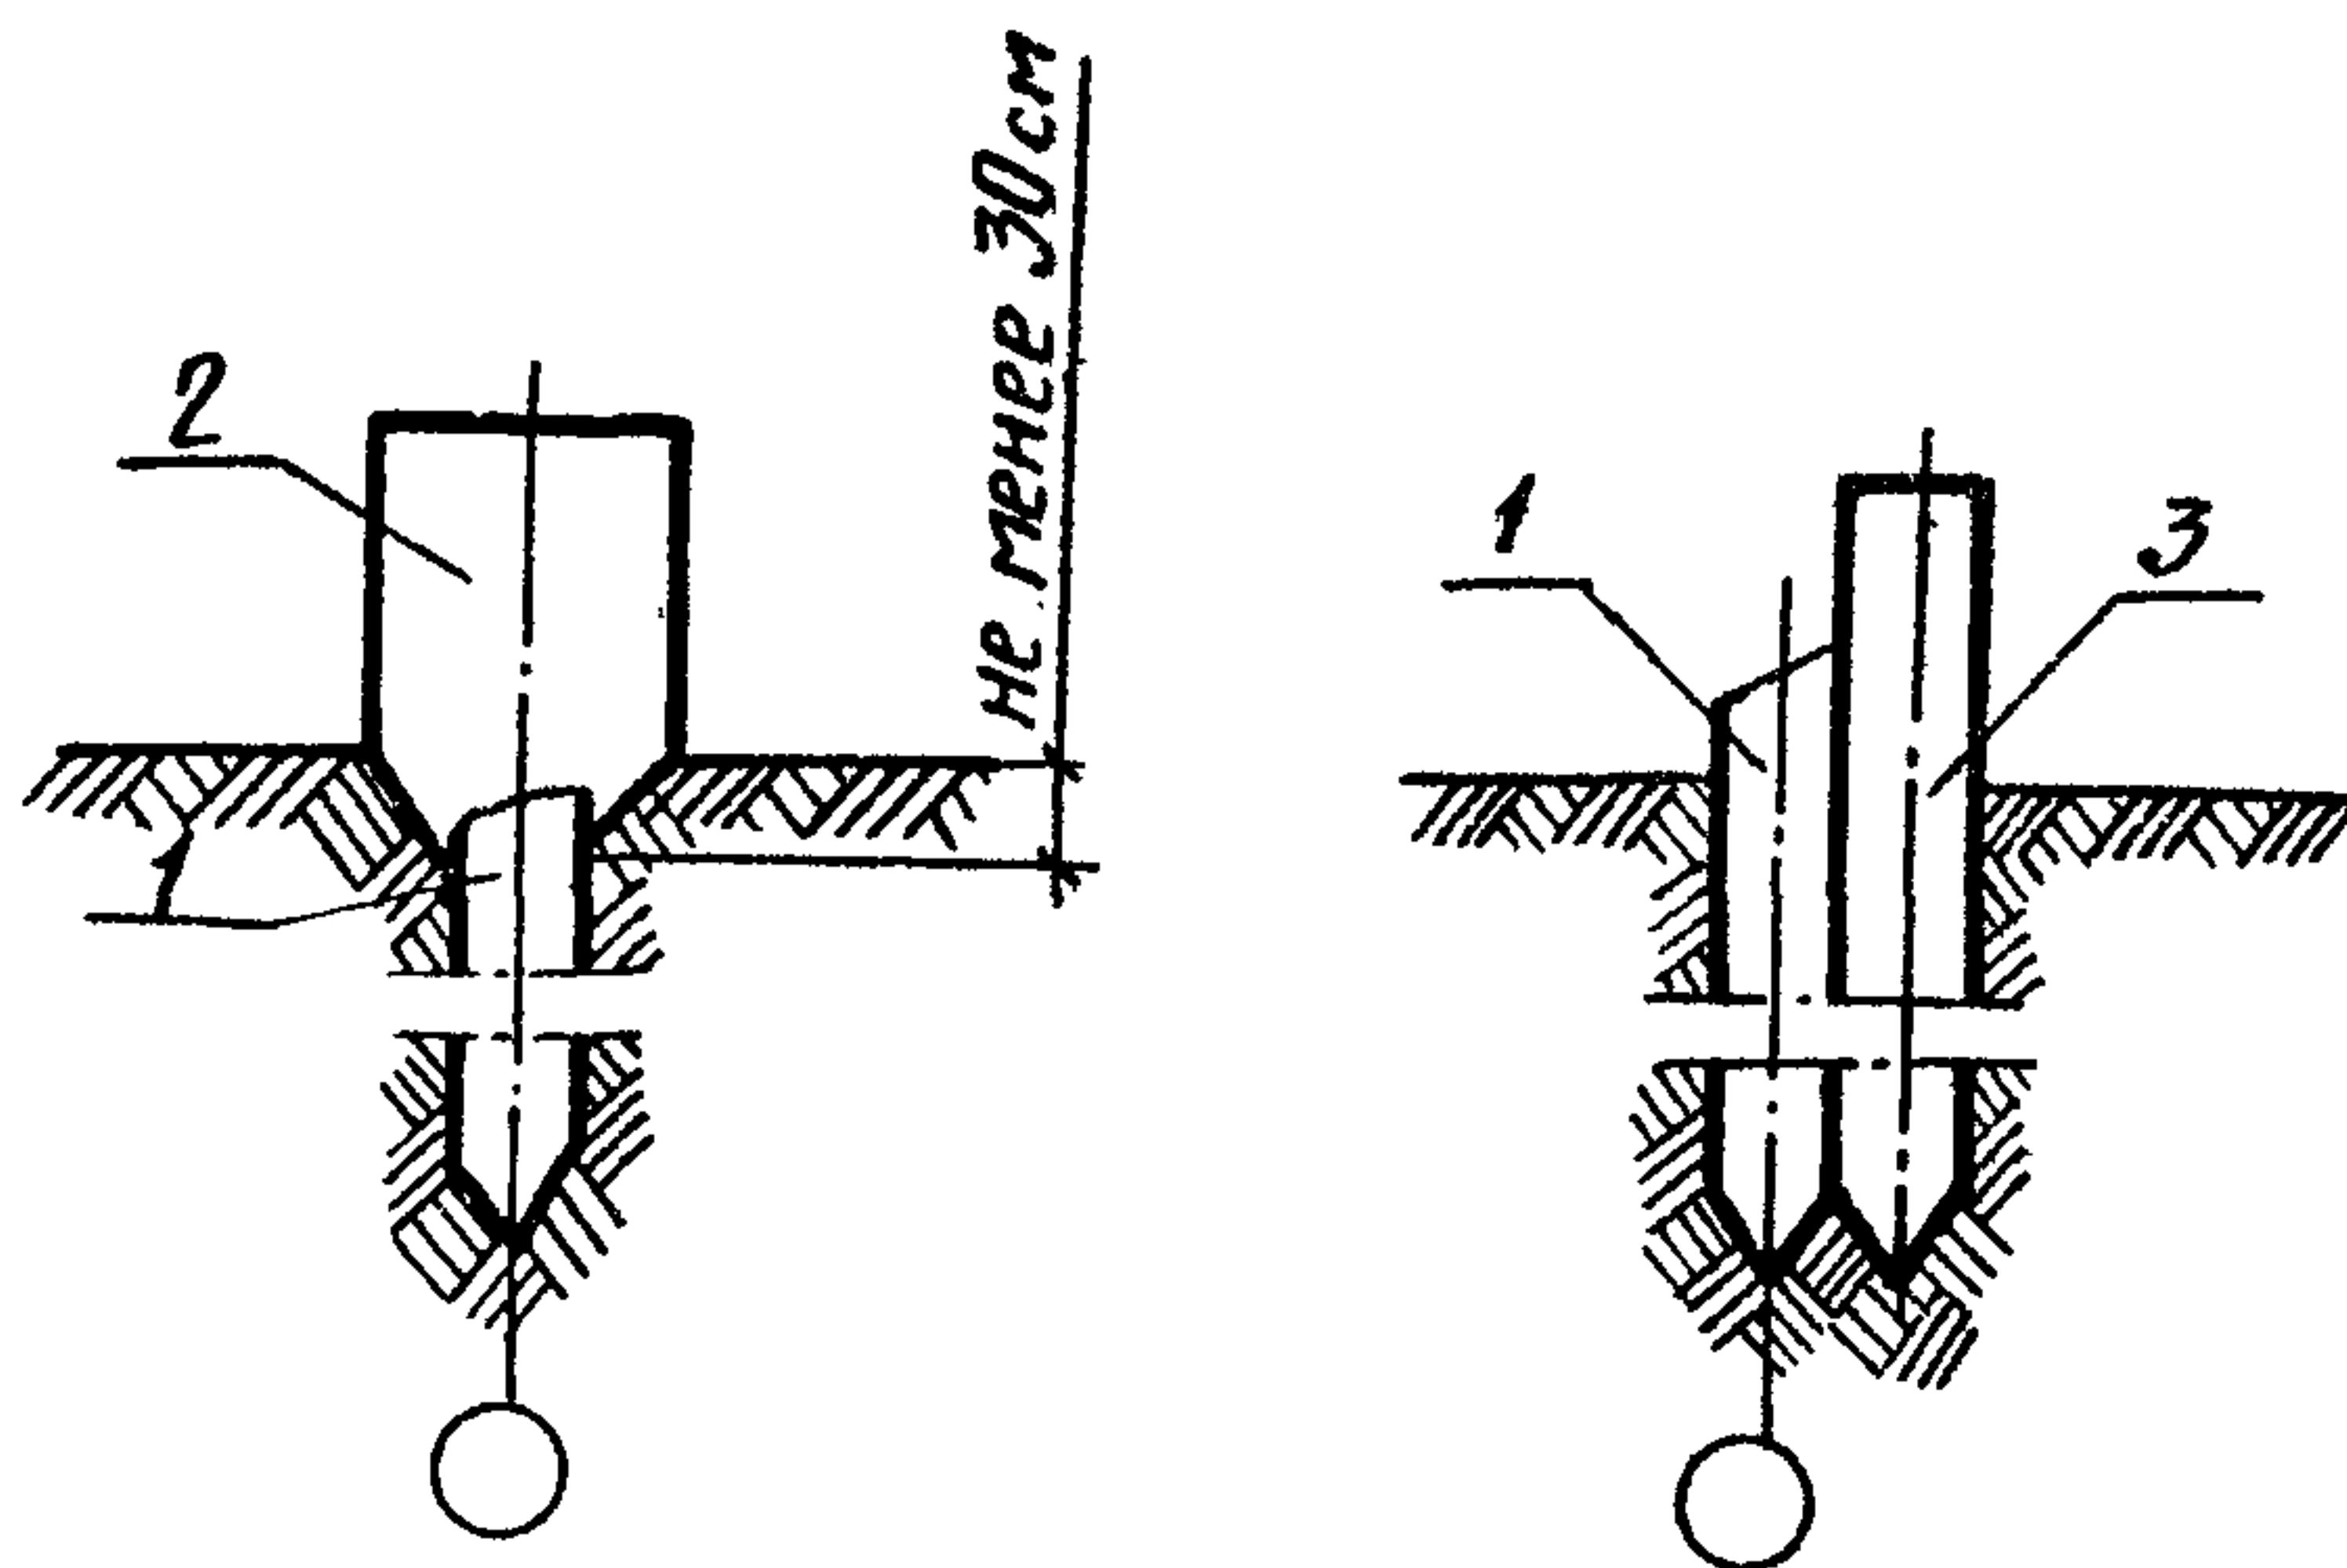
Исправление дефектов при поломке свай: 1-забитая сломанная свая; 2-насадка из сборной оболочки Ø 80 см; 3-свая-дублер
